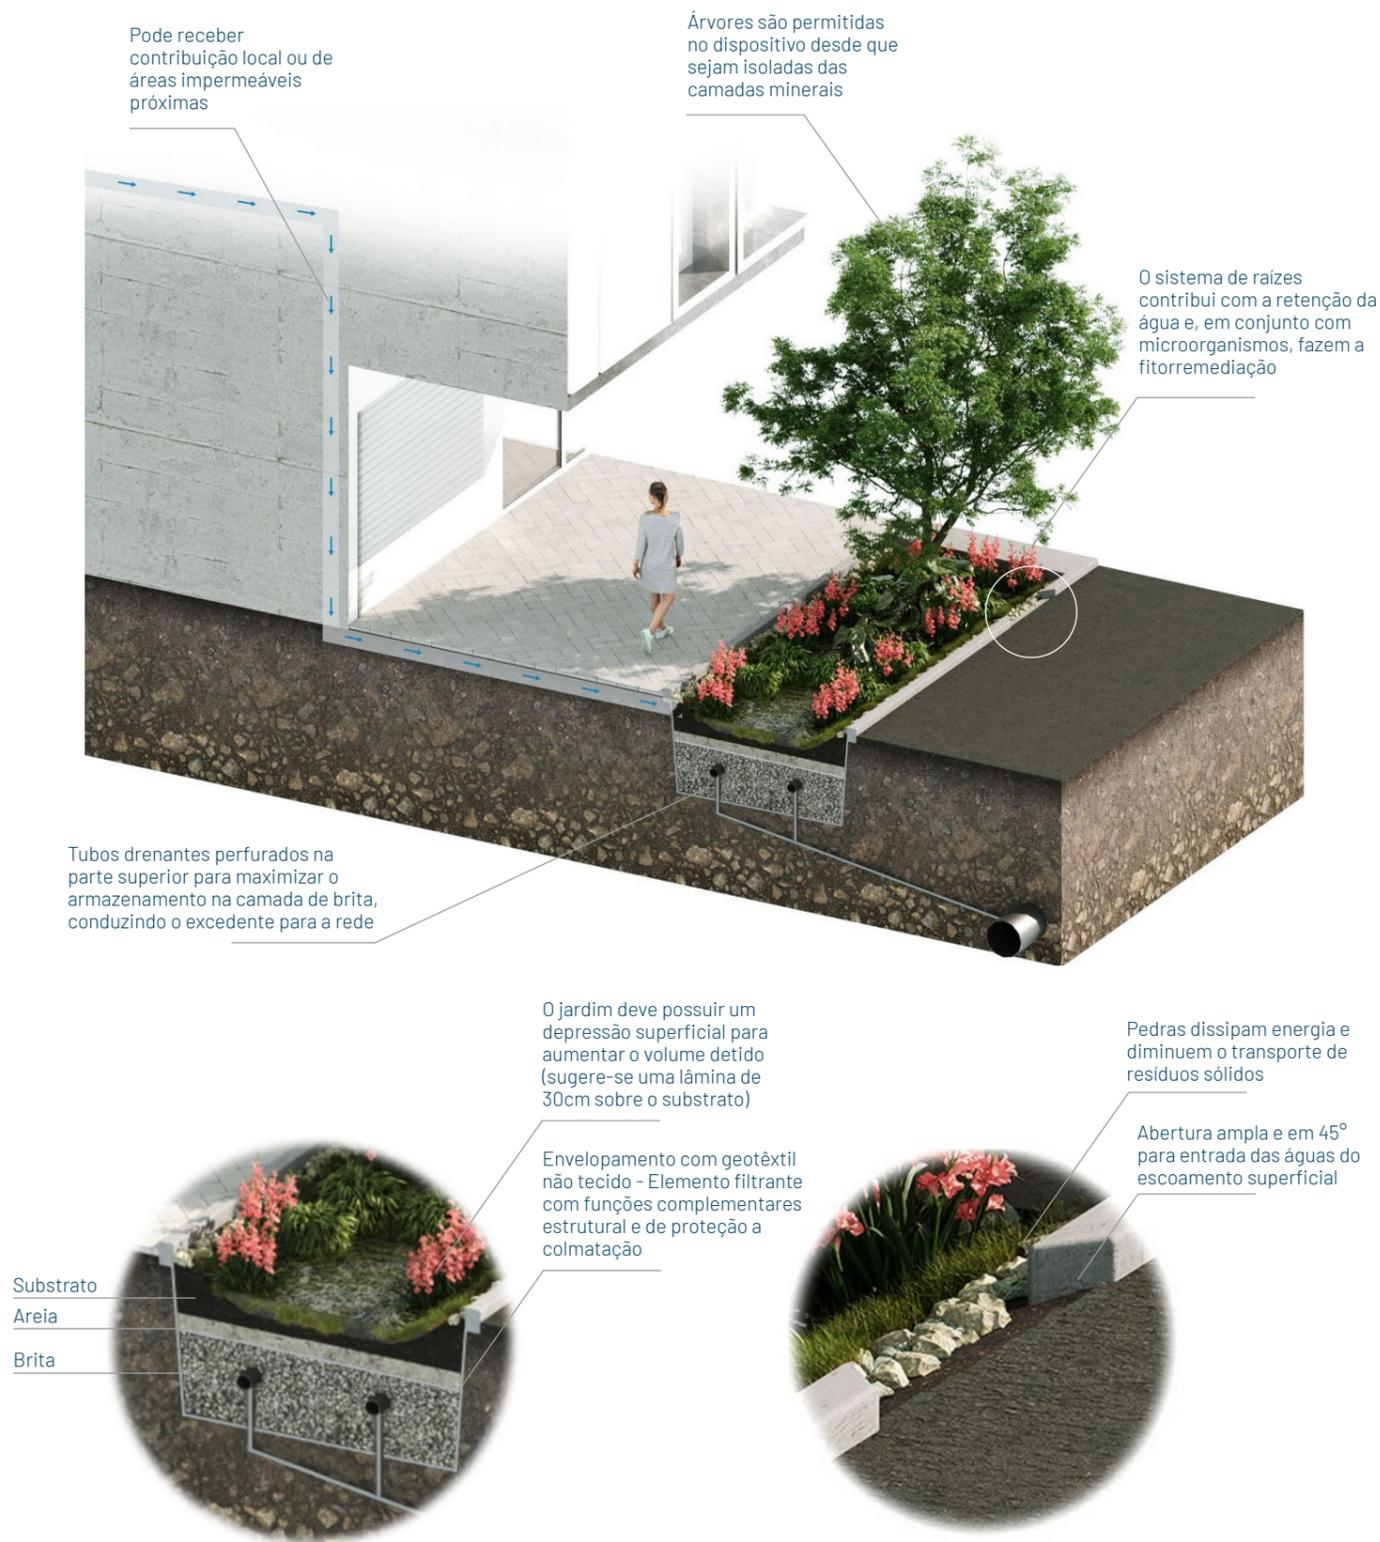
Canteiro Pluvial (Fonte: Guajava, 2023).
